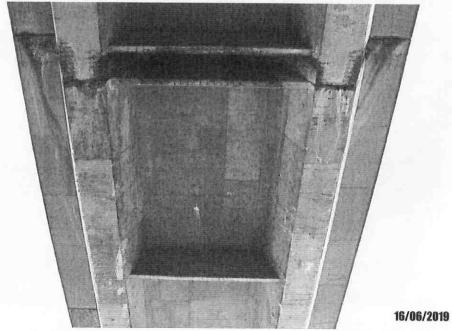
Vista da face inferior do tabuleiro com armadura exposta, eflorescência e vegetação dentro da junta de dilatação.
